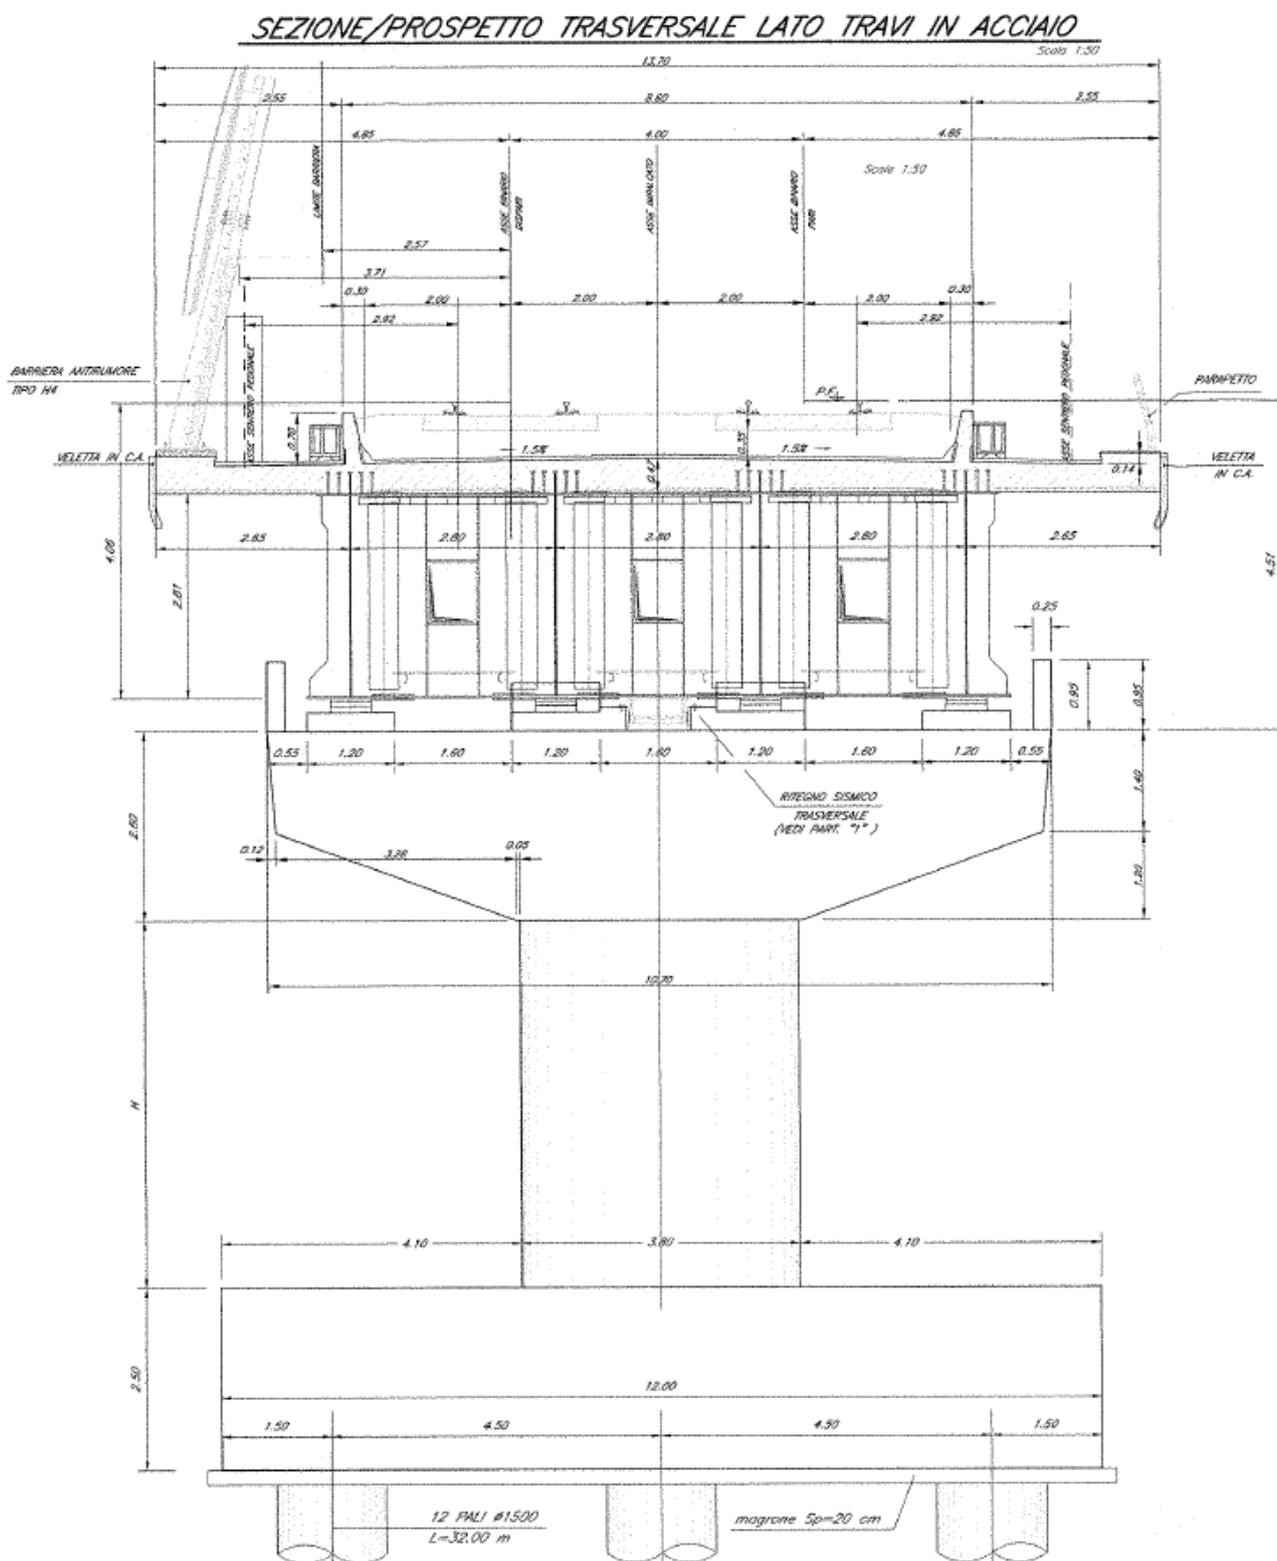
Pila, prospetto frontale – Impalcato in struttura mista acciaio calcestruzzo [m]
